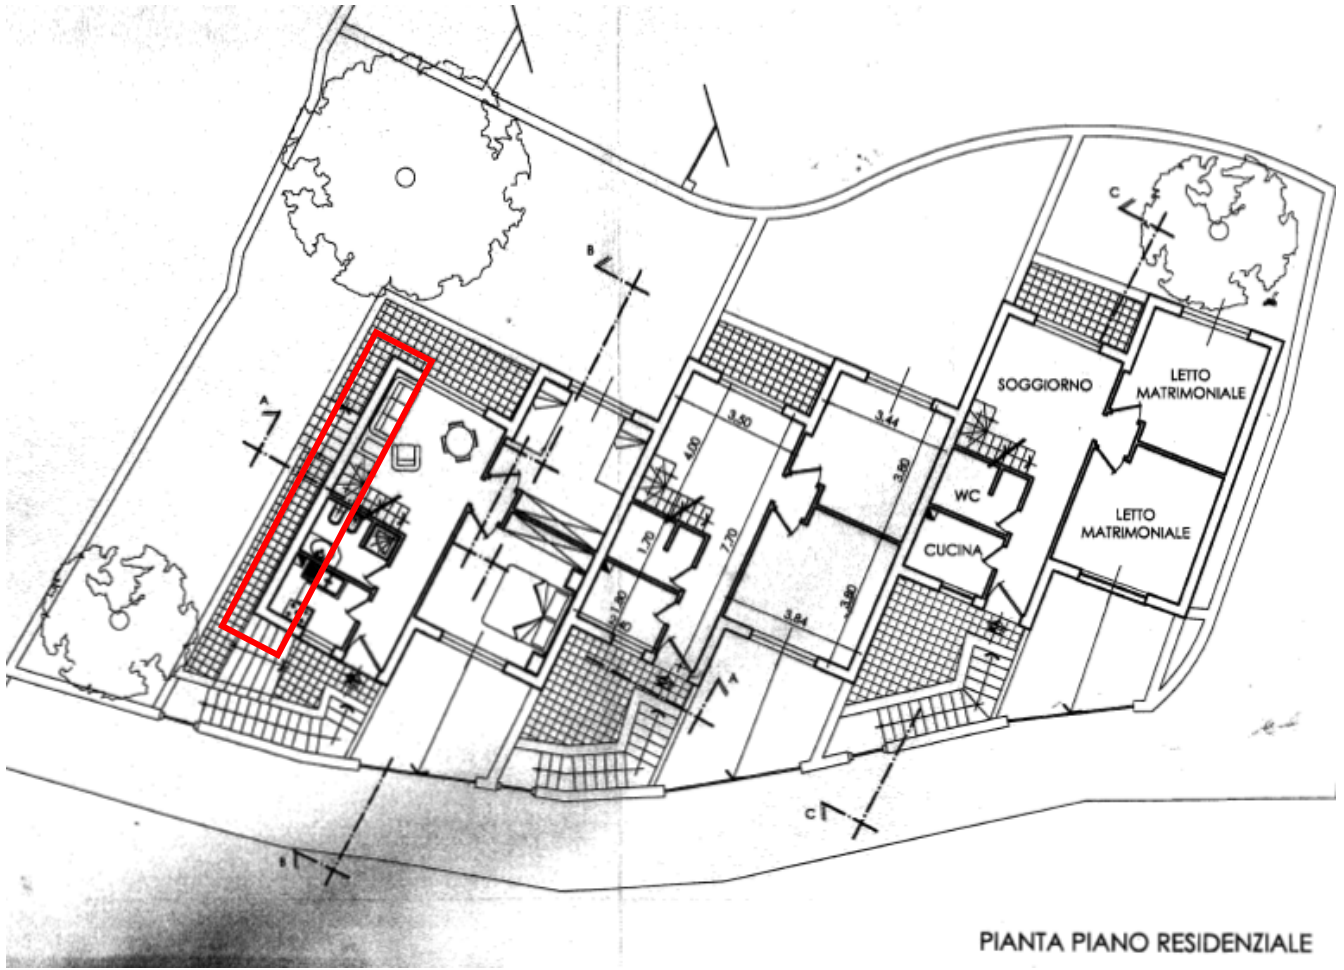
Stralcio progetto approvato – non è presente la finestra sul prospetto Sud
